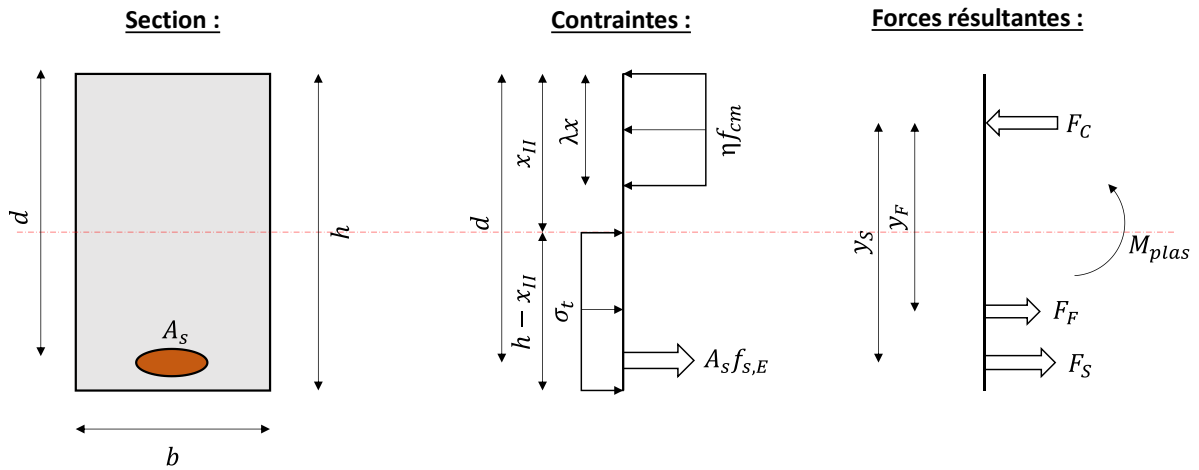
Section élastique fissurée – béton renforcé de fibres
